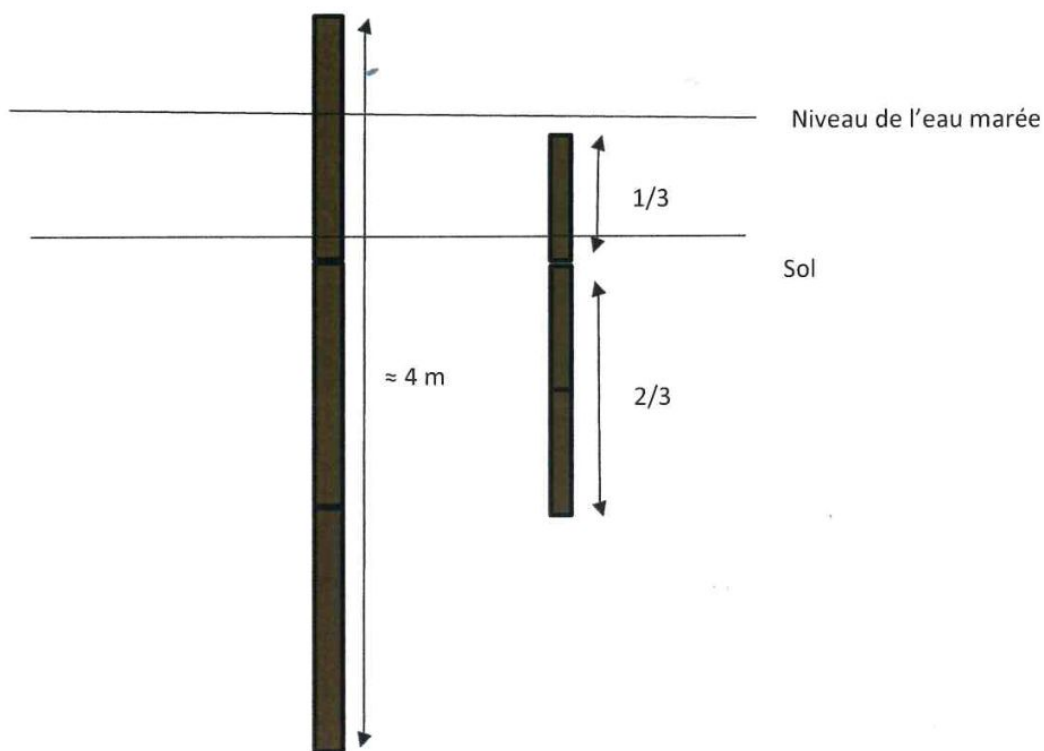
Vue en coupe du dispositif d'accrétion (variante 1)
